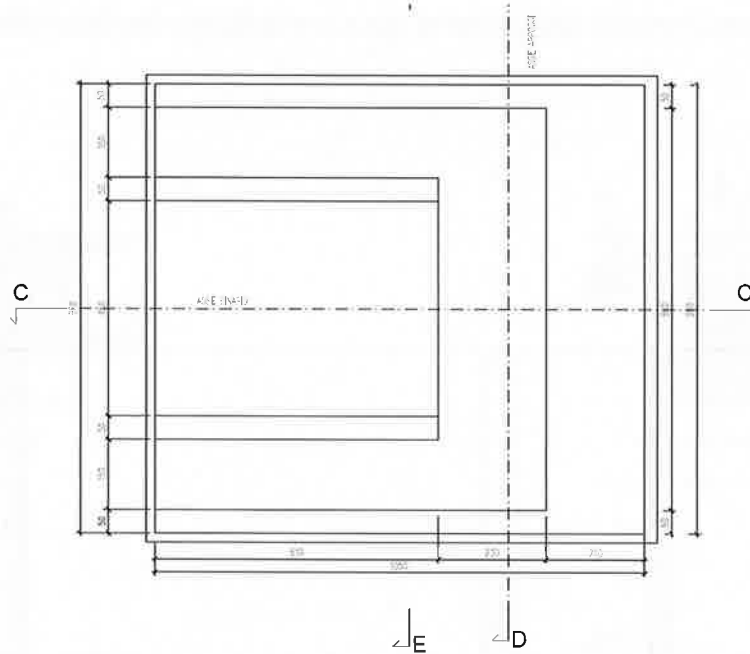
Pianta fondazione spalla A Bauladu VI01
